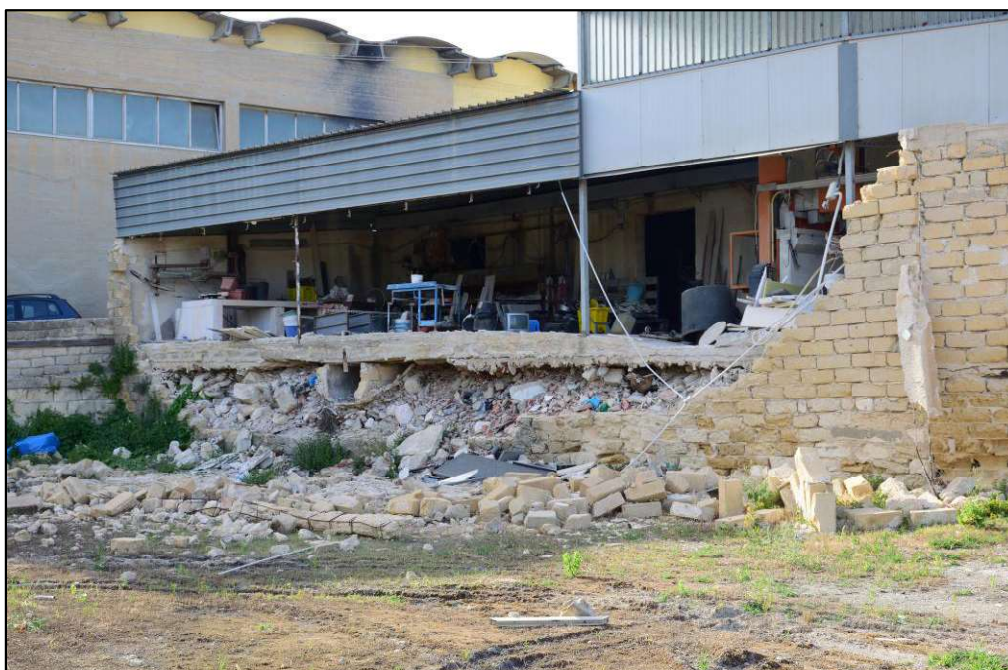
Prospetto sud dell'immobile_Ripresa del 28.05.2021 (a crollo avvenuto)
